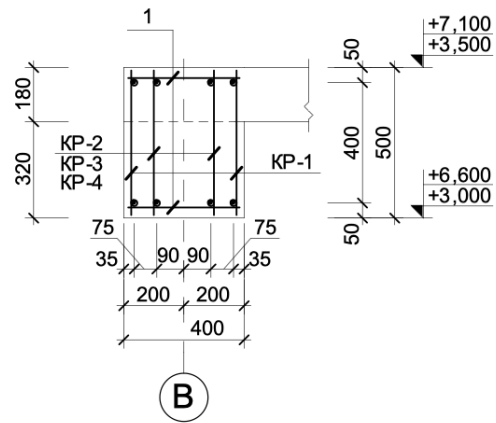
Армування балок перекриття і покриття (розріз 1-1)
